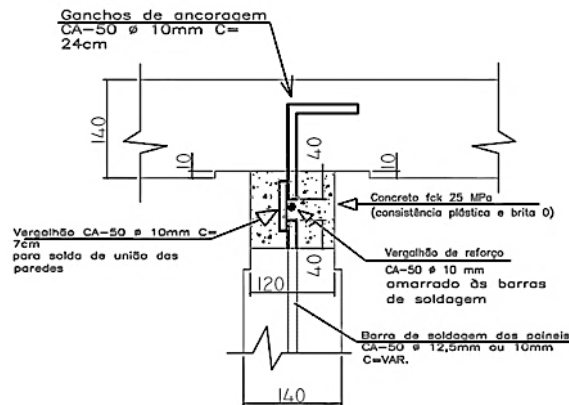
Detalhe esquemático da ligação perpendicular entre painéis.
